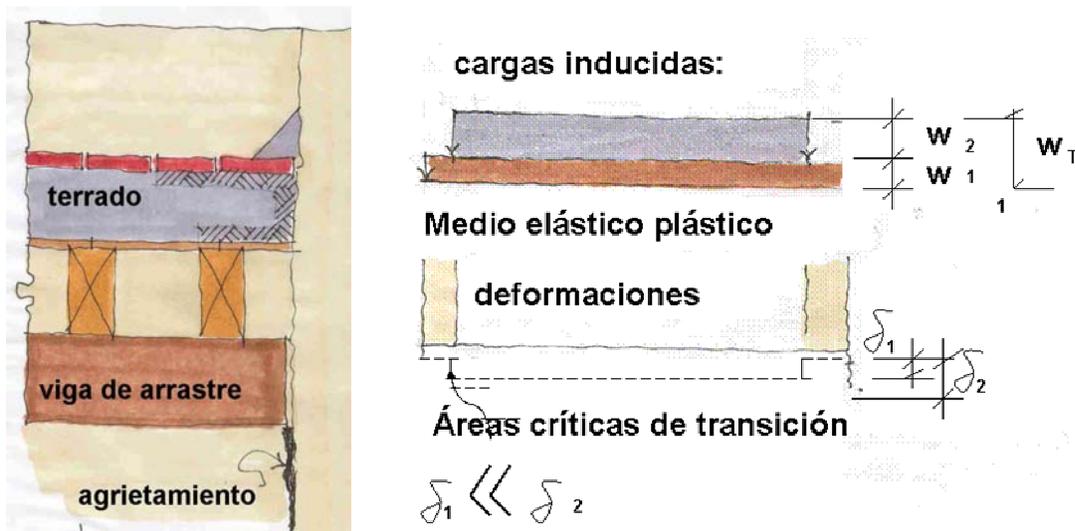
Detalle colocación de vigas de madera y viga de arrastre
